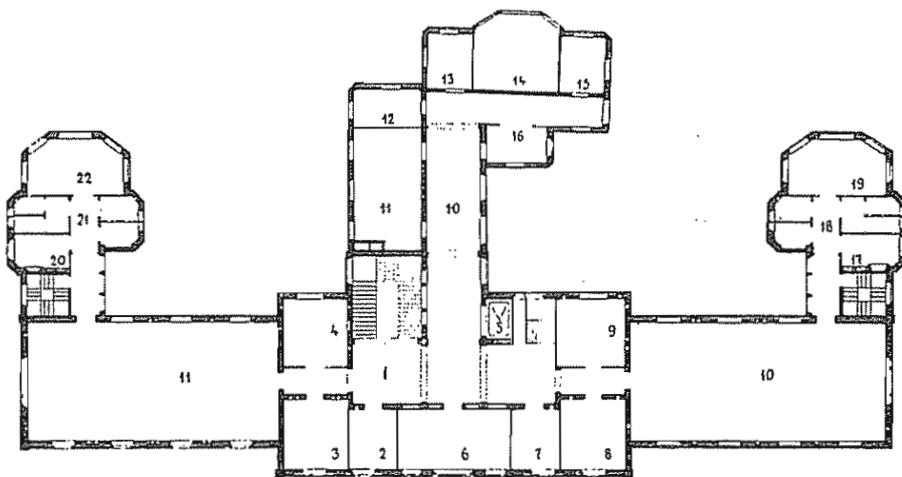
PADIGLIONE CHIRURGICO ZONDA - PIANTA DEL PRIMO PIANO
